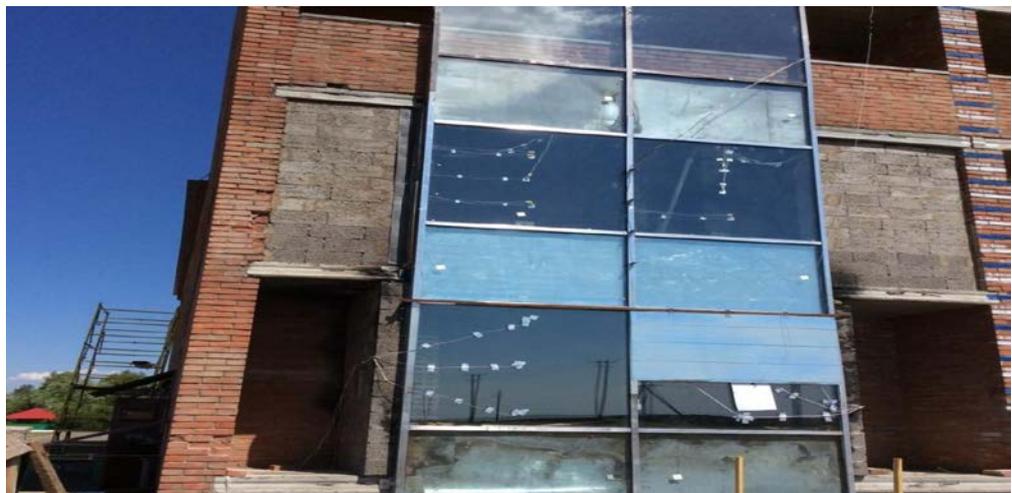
Загальний вигляд світлопрозорого фасаду із захисним екраном
